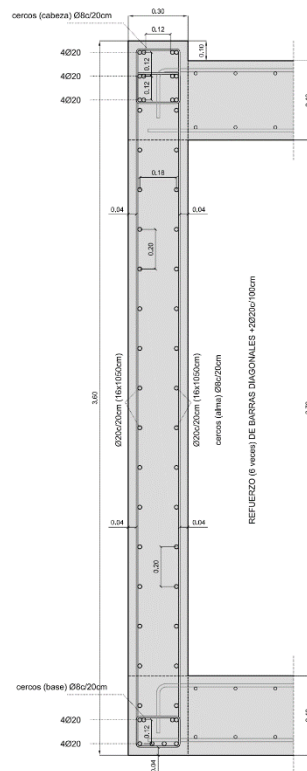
Sección de muro M.01 en tramo superior con armado. Fuente: David Gallardo.
